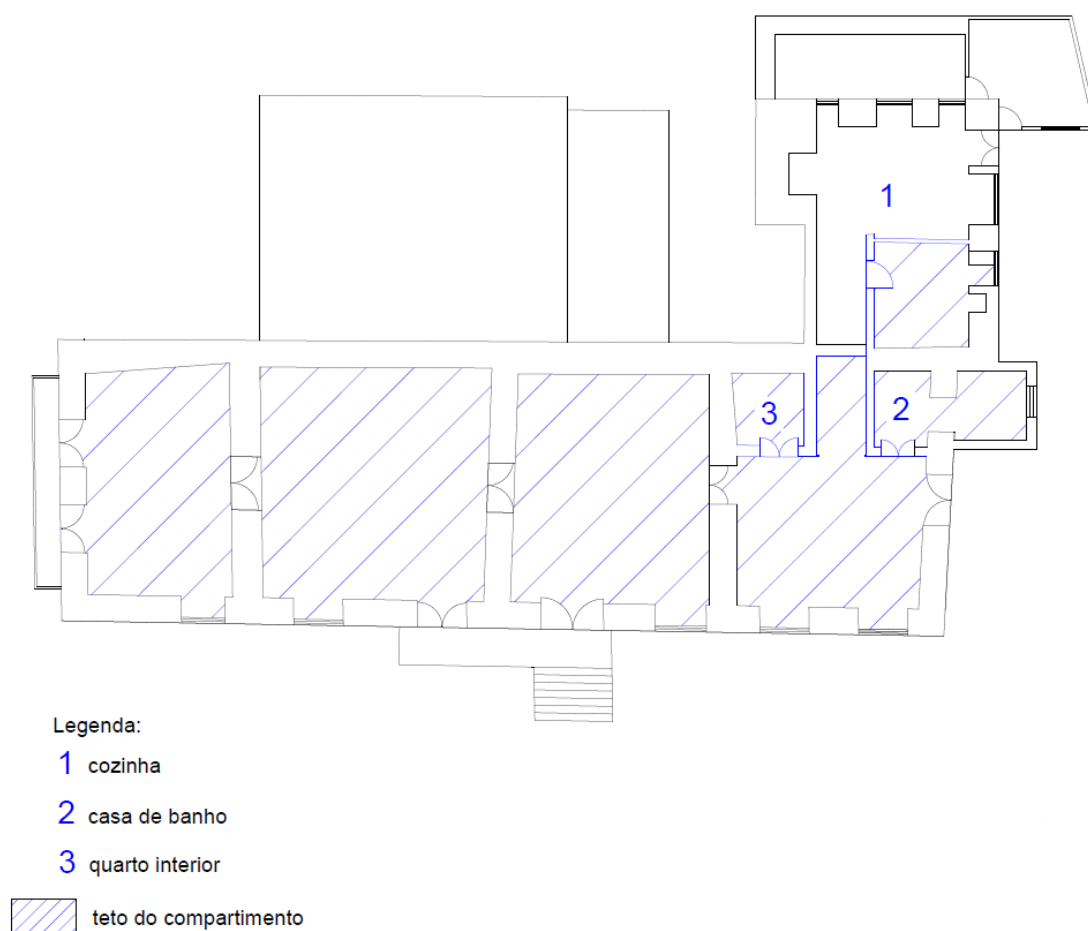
Planta das demolições iniciais a executar e respetiva legenda.
